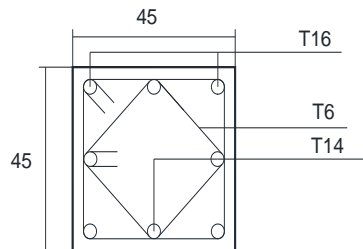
Ferrailage d'un poteau 45x45cm (plan avec longues travées)
